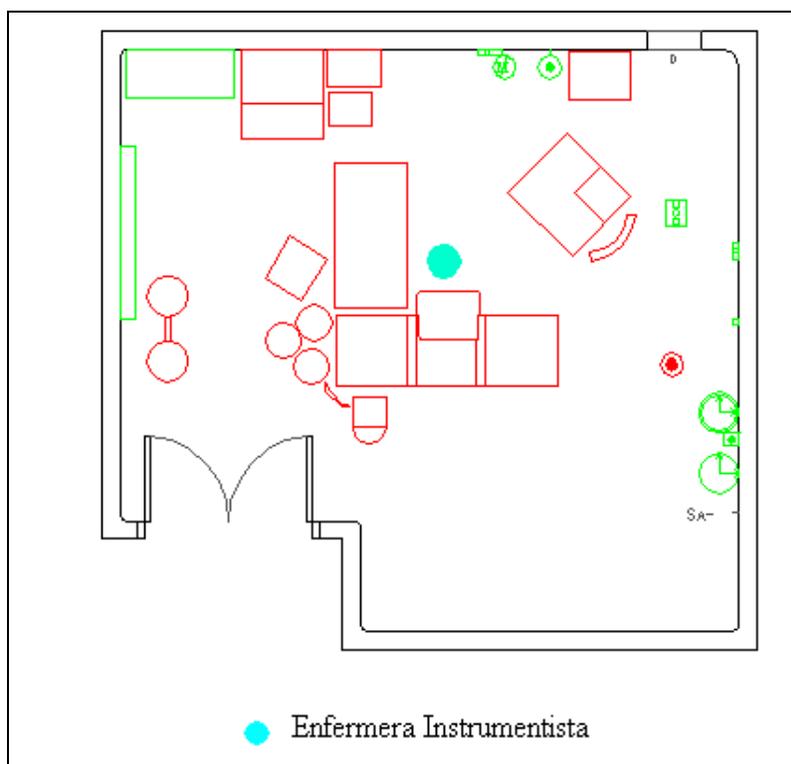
Plano de ubicación de la enfermera instrumentista en la posición 2
